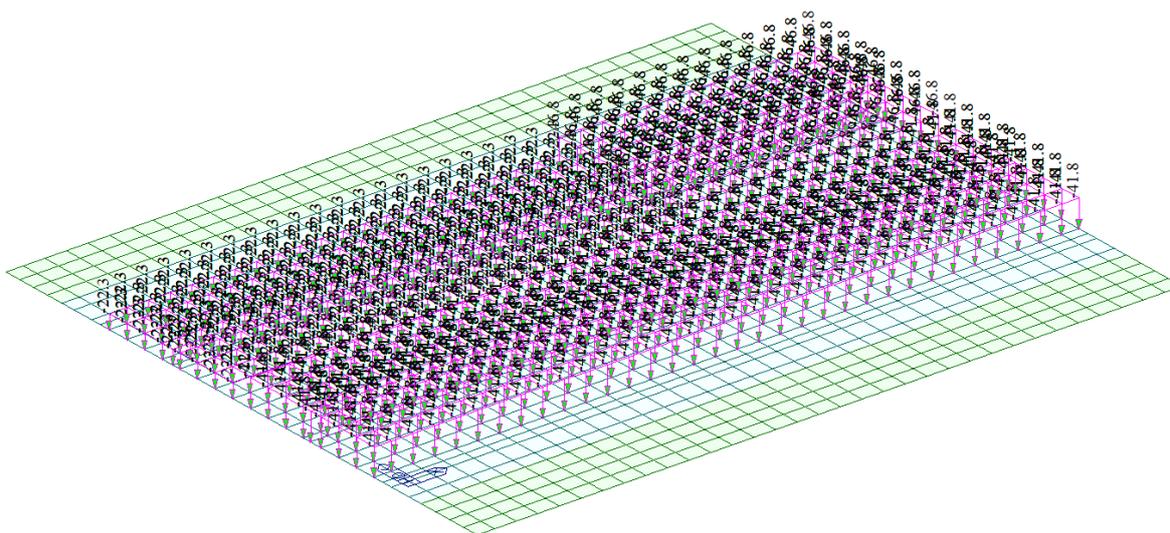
Configurazione tipo delle azioni da traffico per massimizzare lo sforzo normale negli apparecchi di appoggio (lato spalla S2) sull'impalcato (retrotrave carico)
